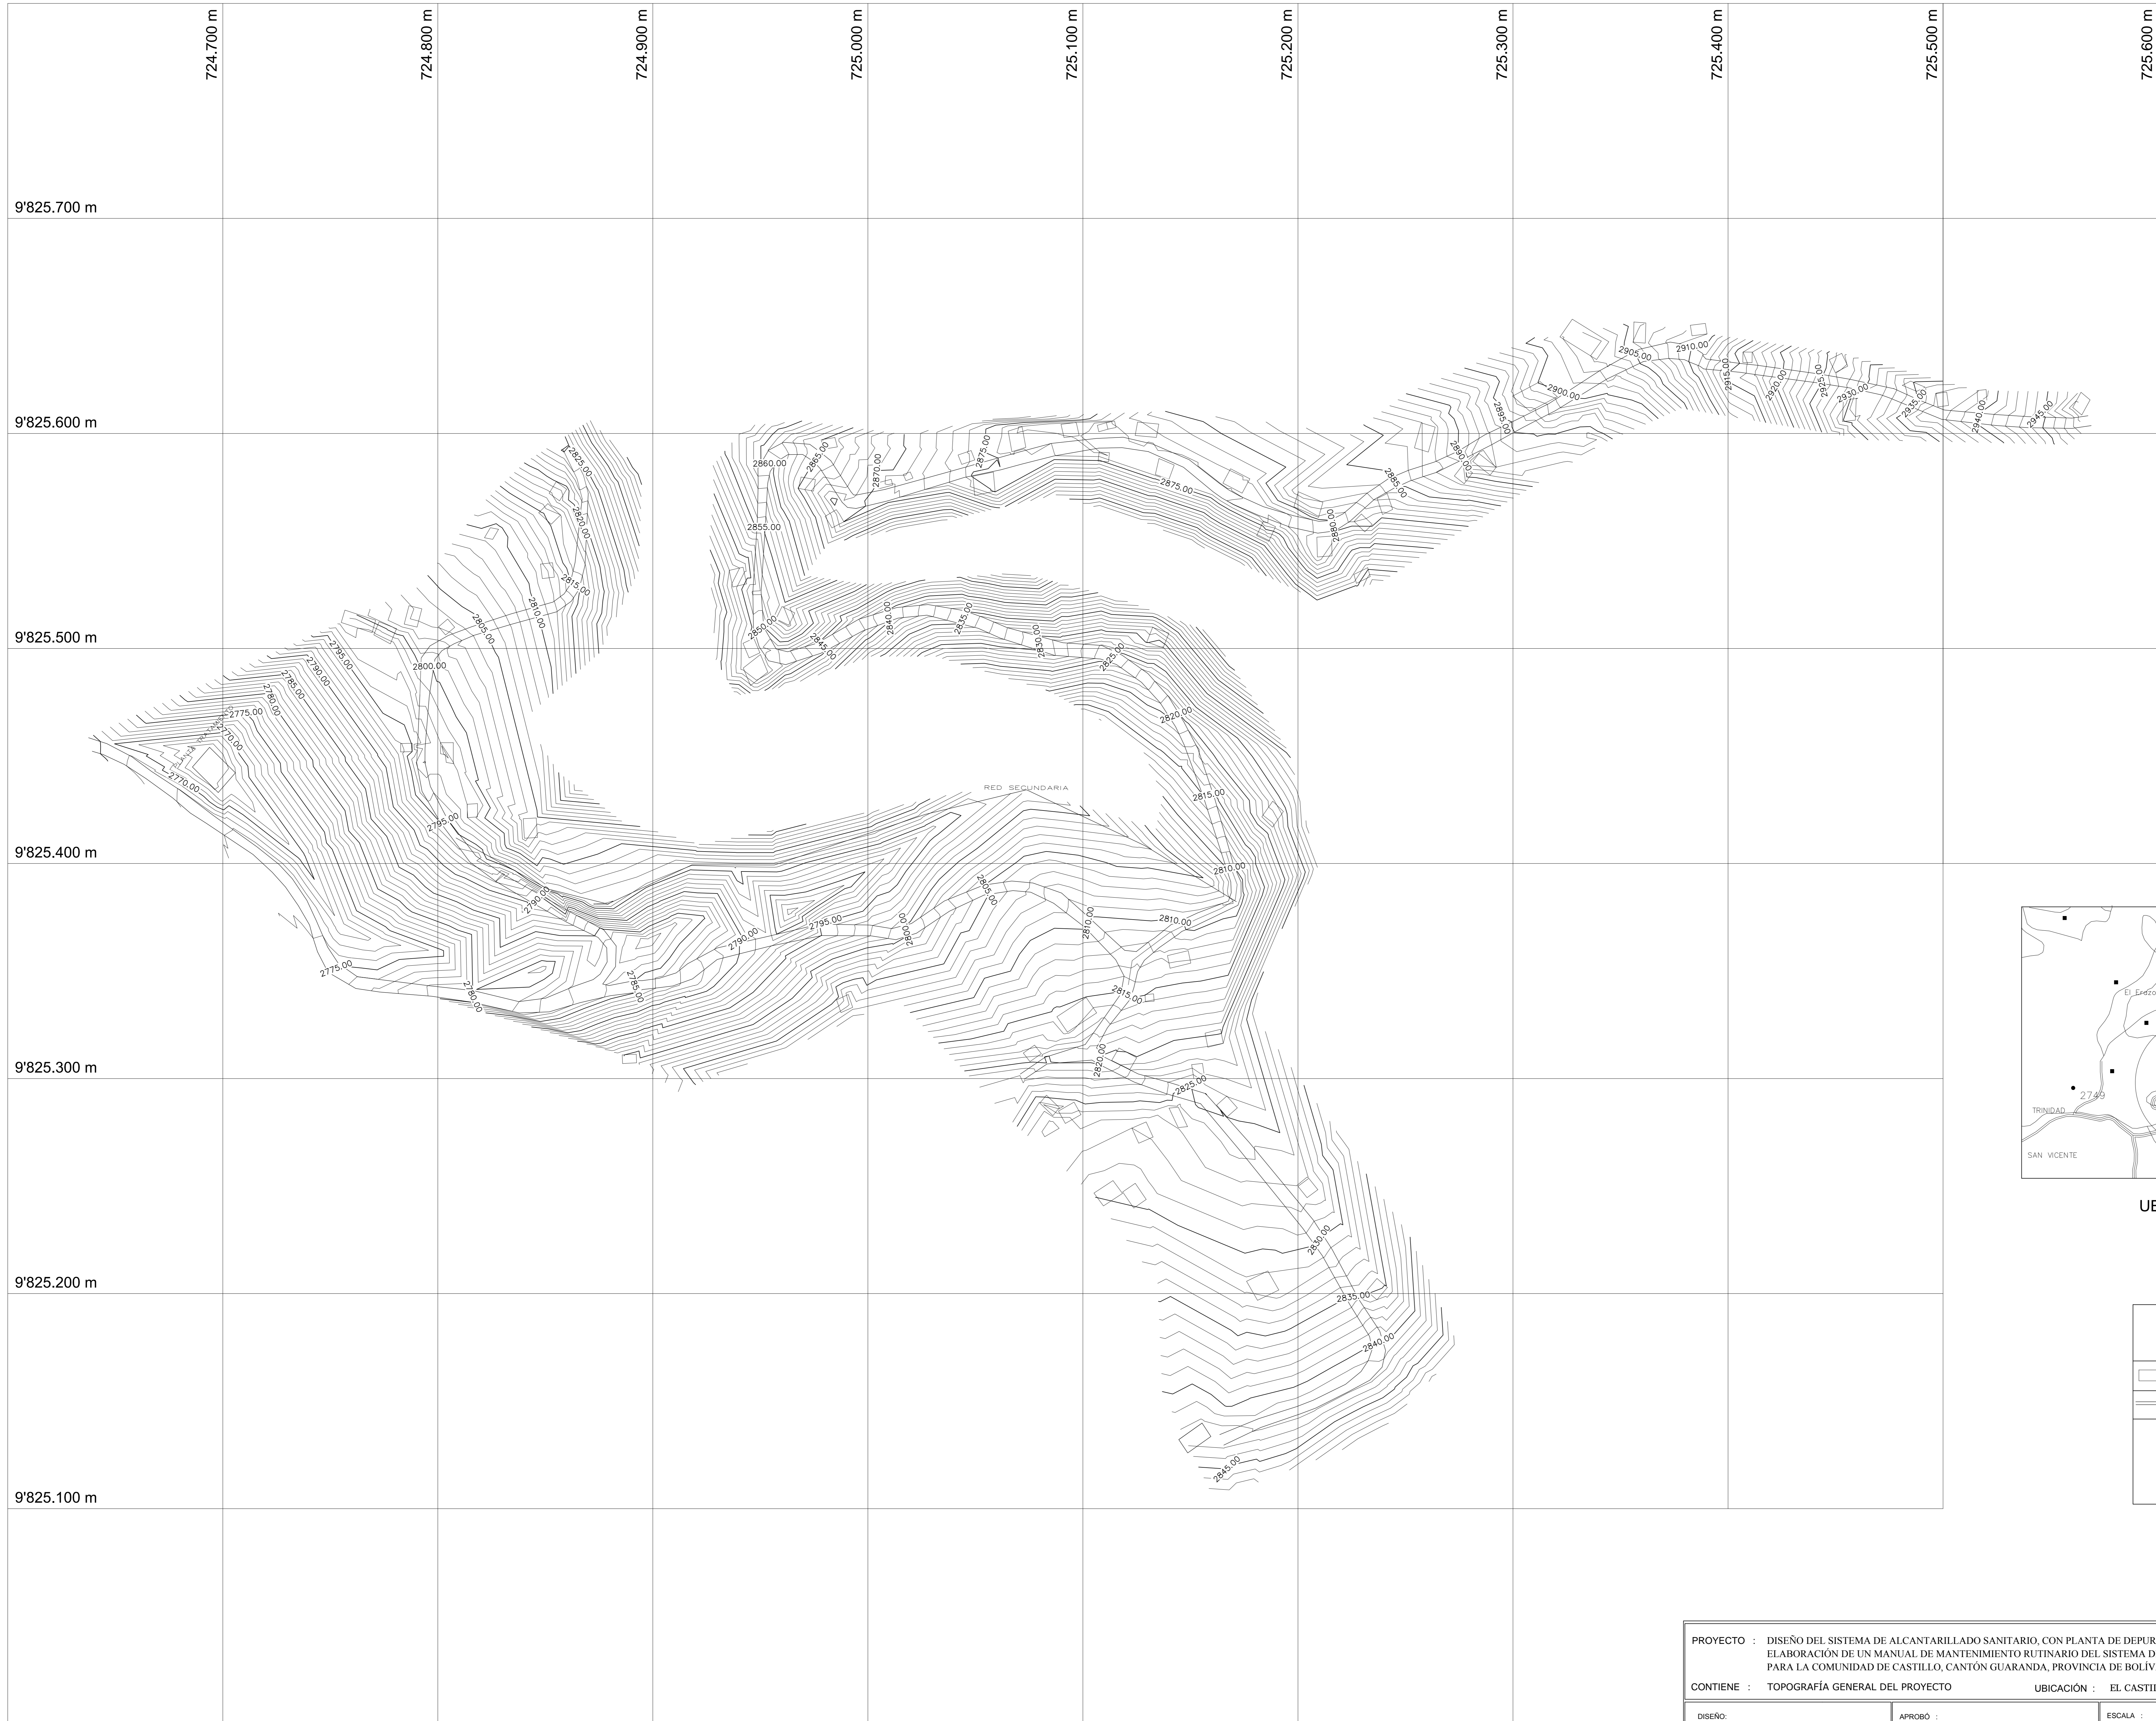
Levantamiento Topográfico – ubicación para la Planta de Tratamiento
